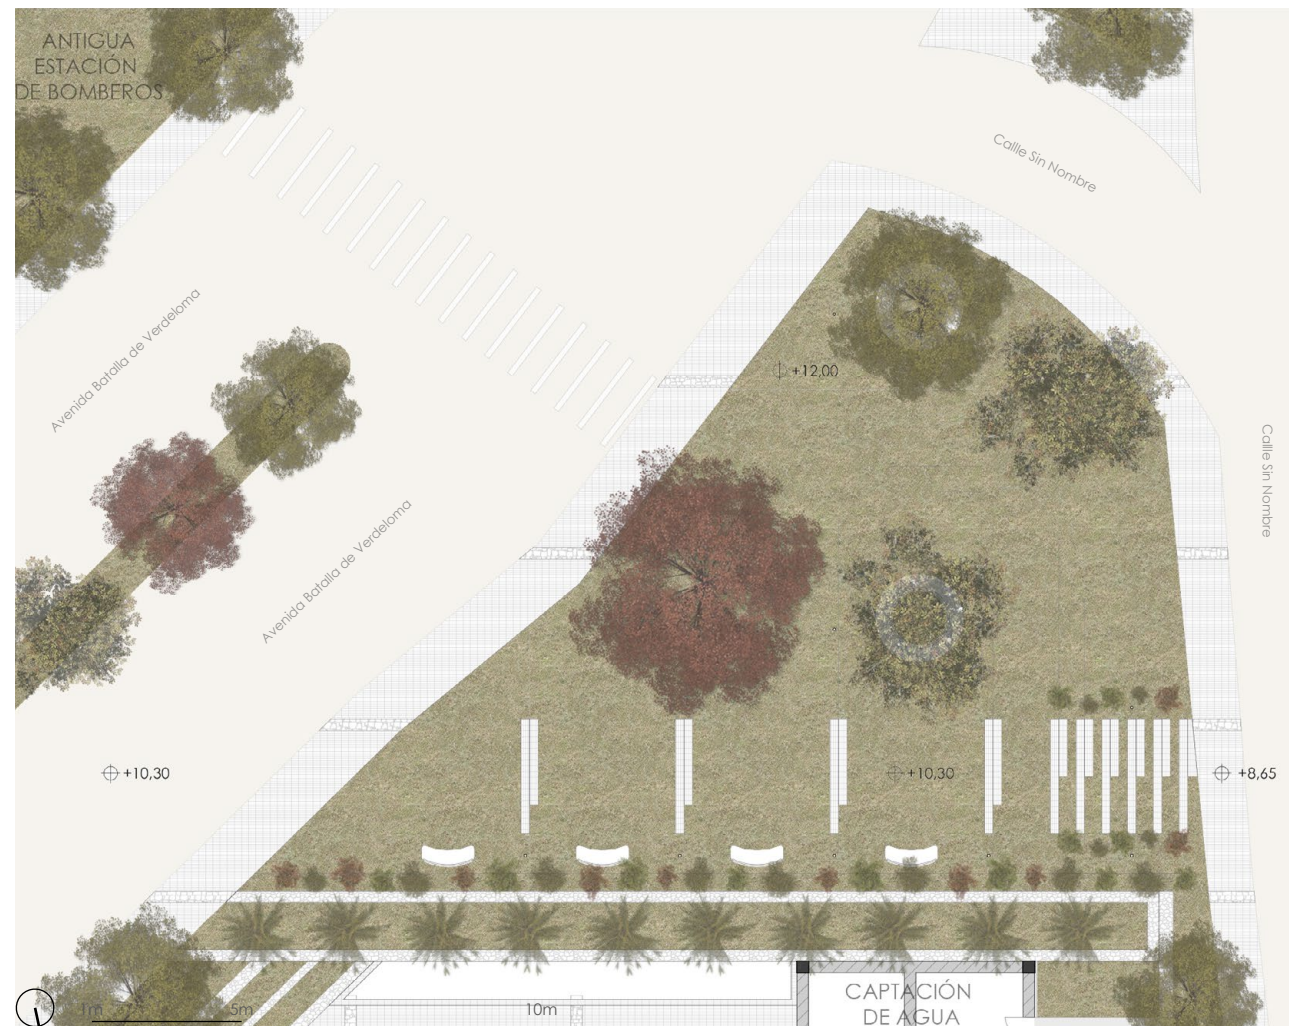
Planta Parque Barrial. Fuente: Autoría propia.
